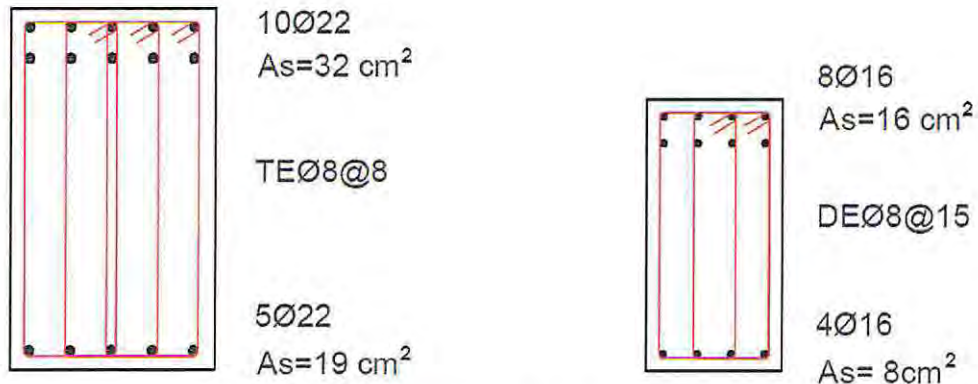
Resumen disposición de la armadura viga 1 y 2.
